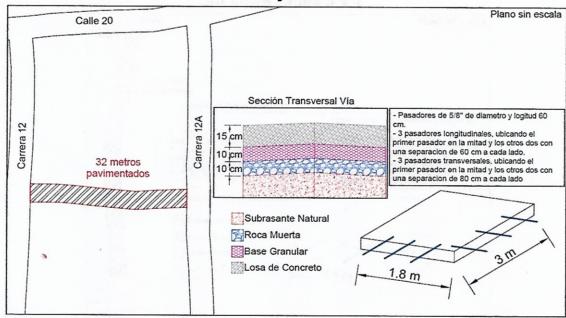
Plano y sección transversal Pasaje Vera – barrio Bolivariano
